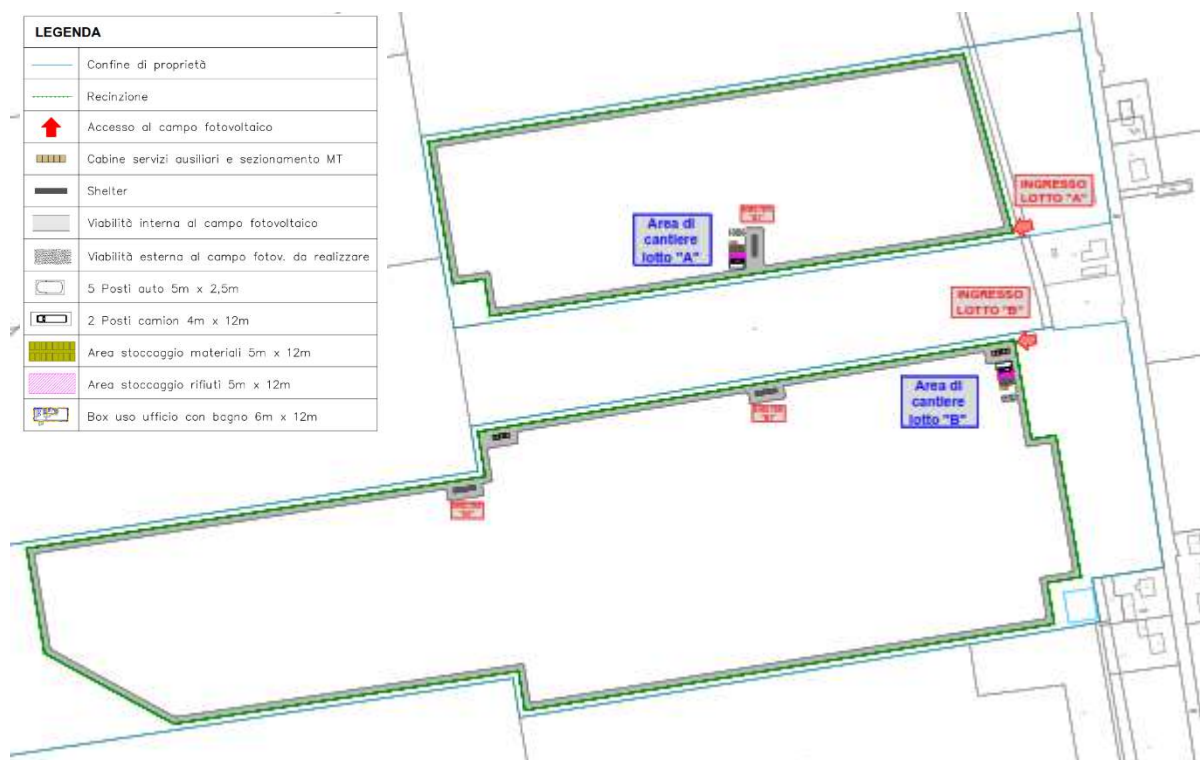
Posizionamento area di cantiere temporaneo Blocchi "A" – "B"
